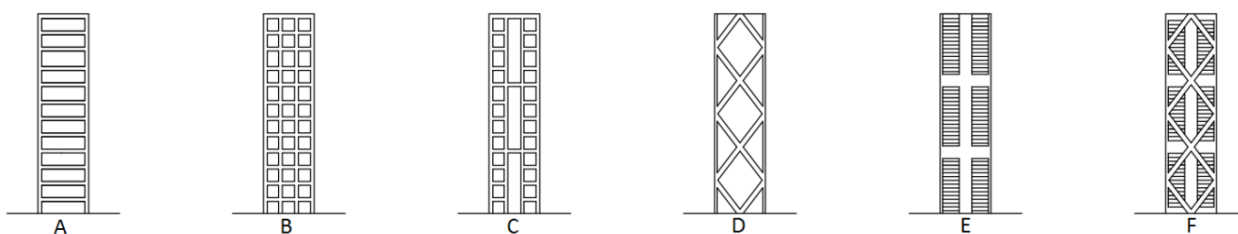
Diferentes sistemas estruturais: A) pórtico tubular, B) associação de tubos, C) tubo dentro de tubo, D) *diagrid*, E) *outriggers* e F) estrutura híbrida, (Hallebrand e Jakobsson, 2016)
